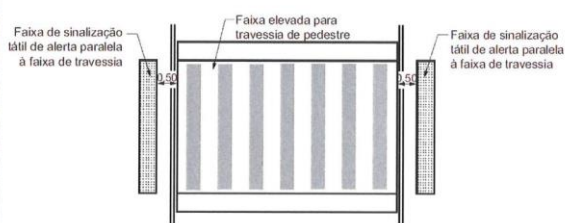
Faixa elevada (Figura 27 da NBR 16537/2016)
